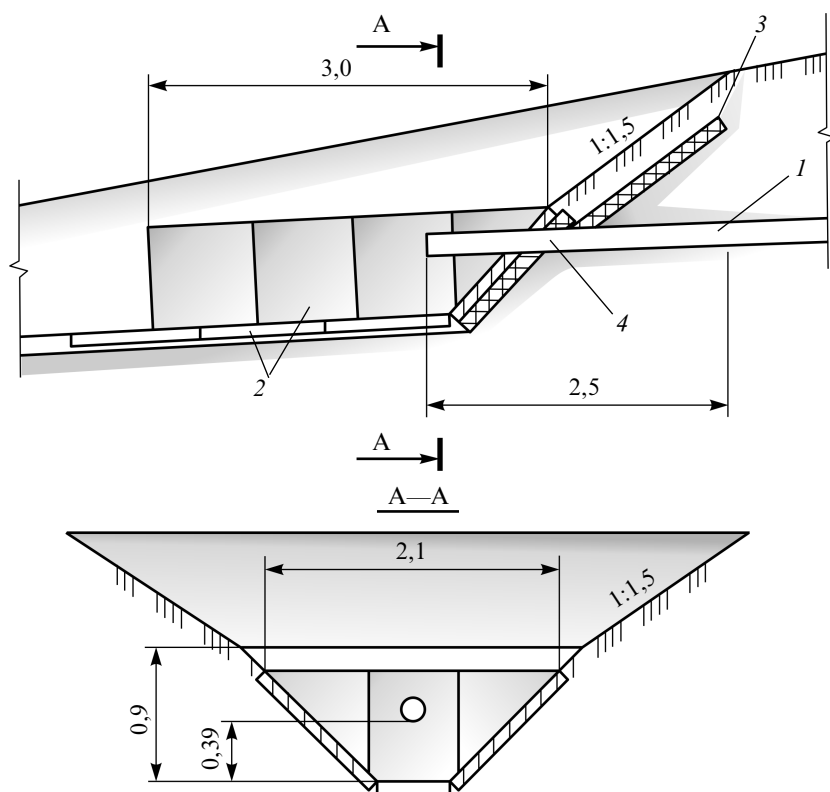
Выпуск дренажа с лотком из бетонных плит и утеплителем:
